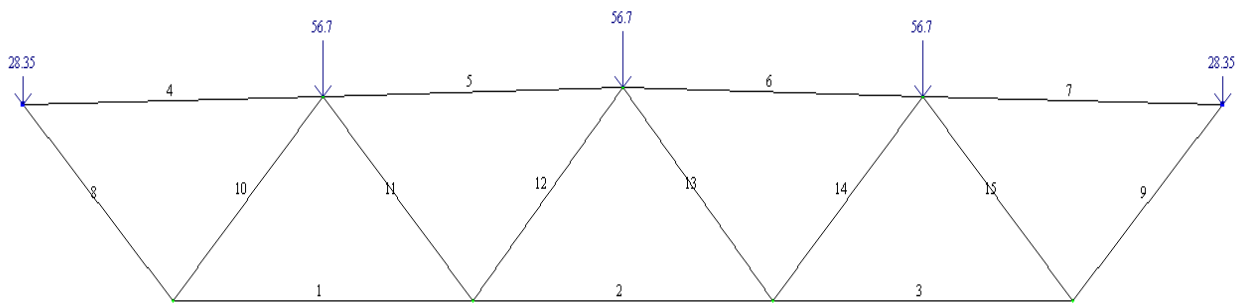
Схема загрузки фермы кратковременной нагрузкой
